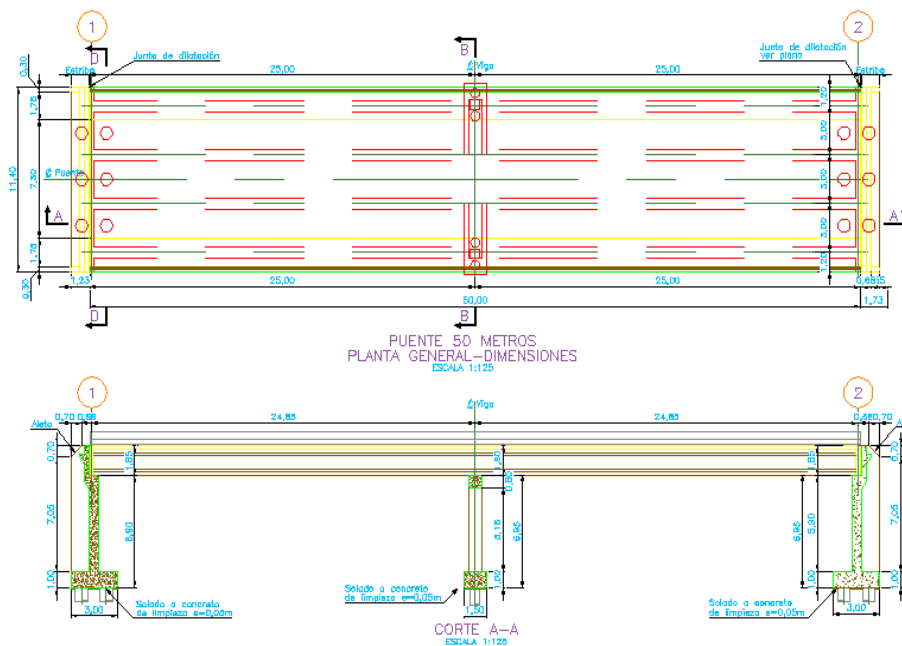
Sección Longitudinal en Planta y Corte – Puente 1
